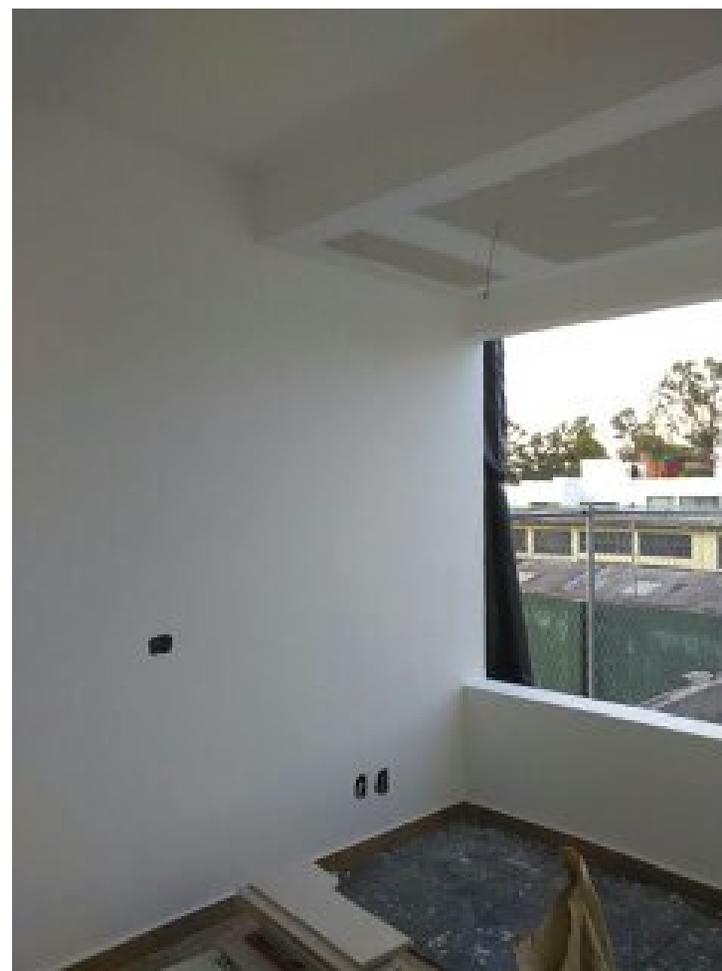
Cajillo en plafón para paso de instalaciones en recámara.
